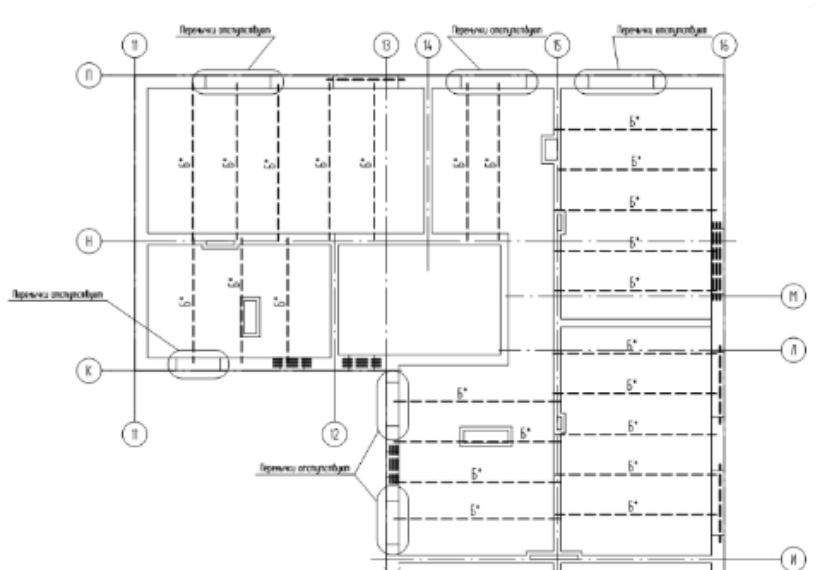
Фрагмент схемы расположения балок перекрытия и наличия надоконных перемычек второго этажа «Дома пожарных»
